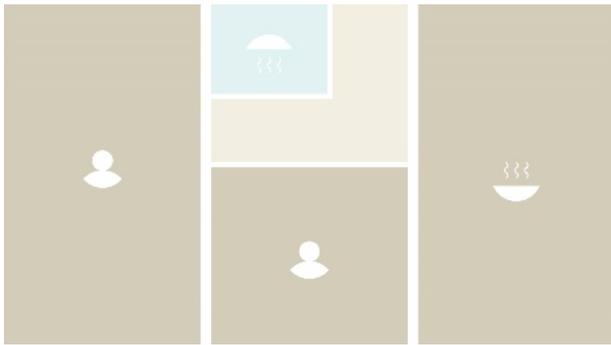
Schema Grundriss 3-Zimmer kompakt inkl. Wohnküche (Architekt Schweizer)
